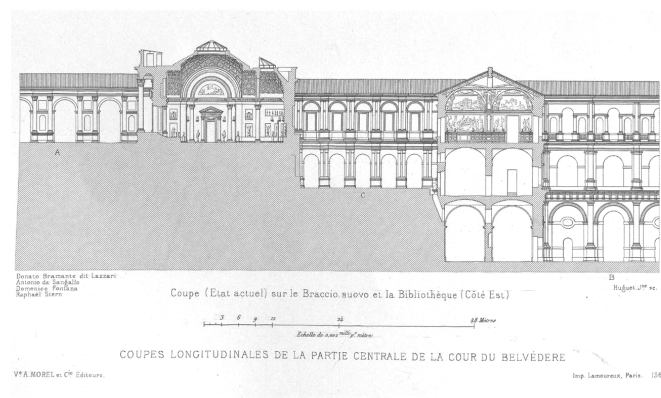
Cortile di Belvedere in Vaticano, particolare con sezione della Biblioteca Vaticana (da P.M. Letarouilly, *Le Vatican et la Basilique de Saint Pierre de Rome*, II, Paris 1882, tav. 6).
